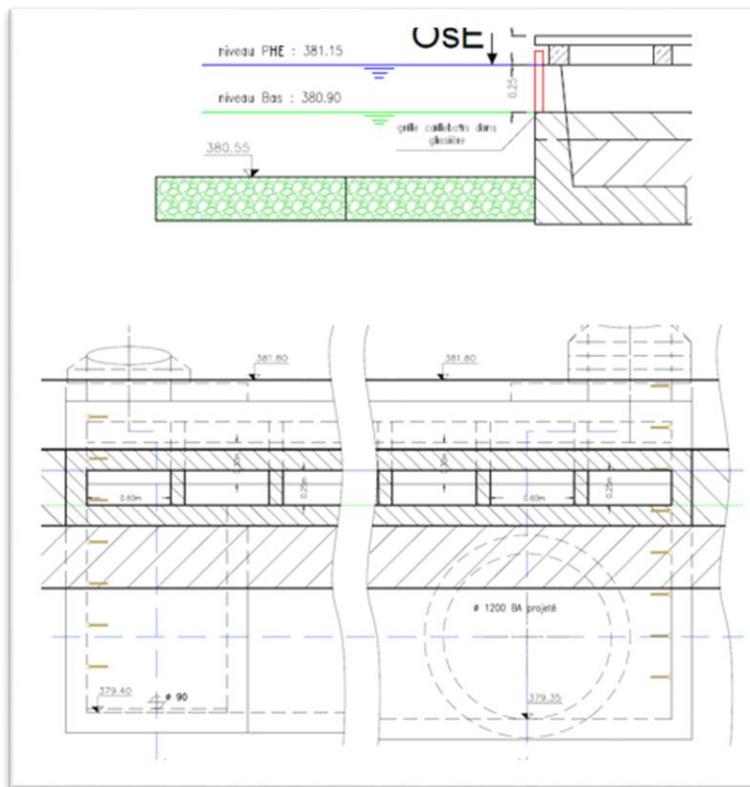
Plans des ouvrages de l'étang de Cravanche
